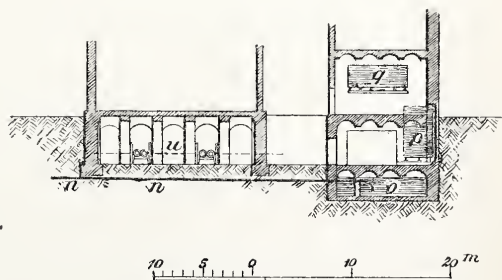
u. 3. Grundriss und Schnitt vom Dekorations-Magazin.
